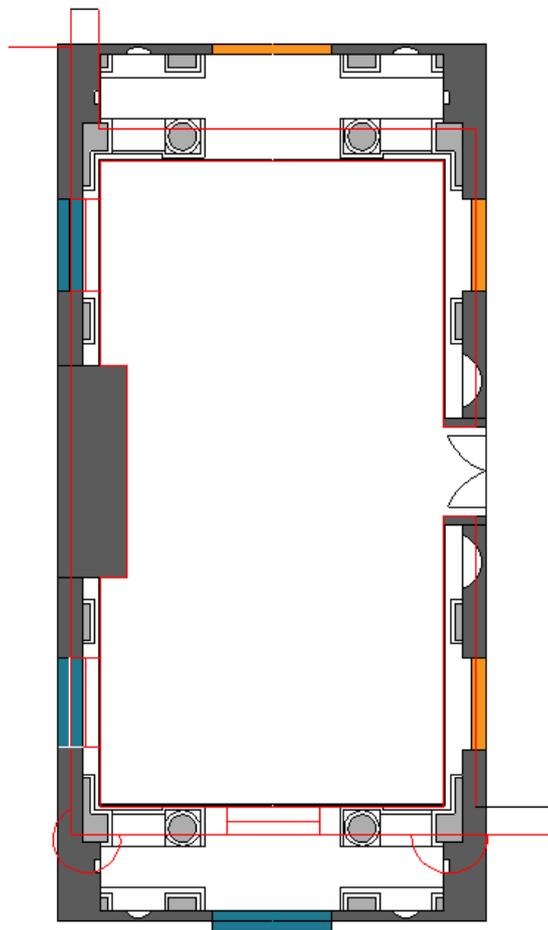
Villa Barbaro, Stanza di Bacco: Überlagerung der Scheinarchitektur mit dem realen Raumgrundriss der Villa (rot).
